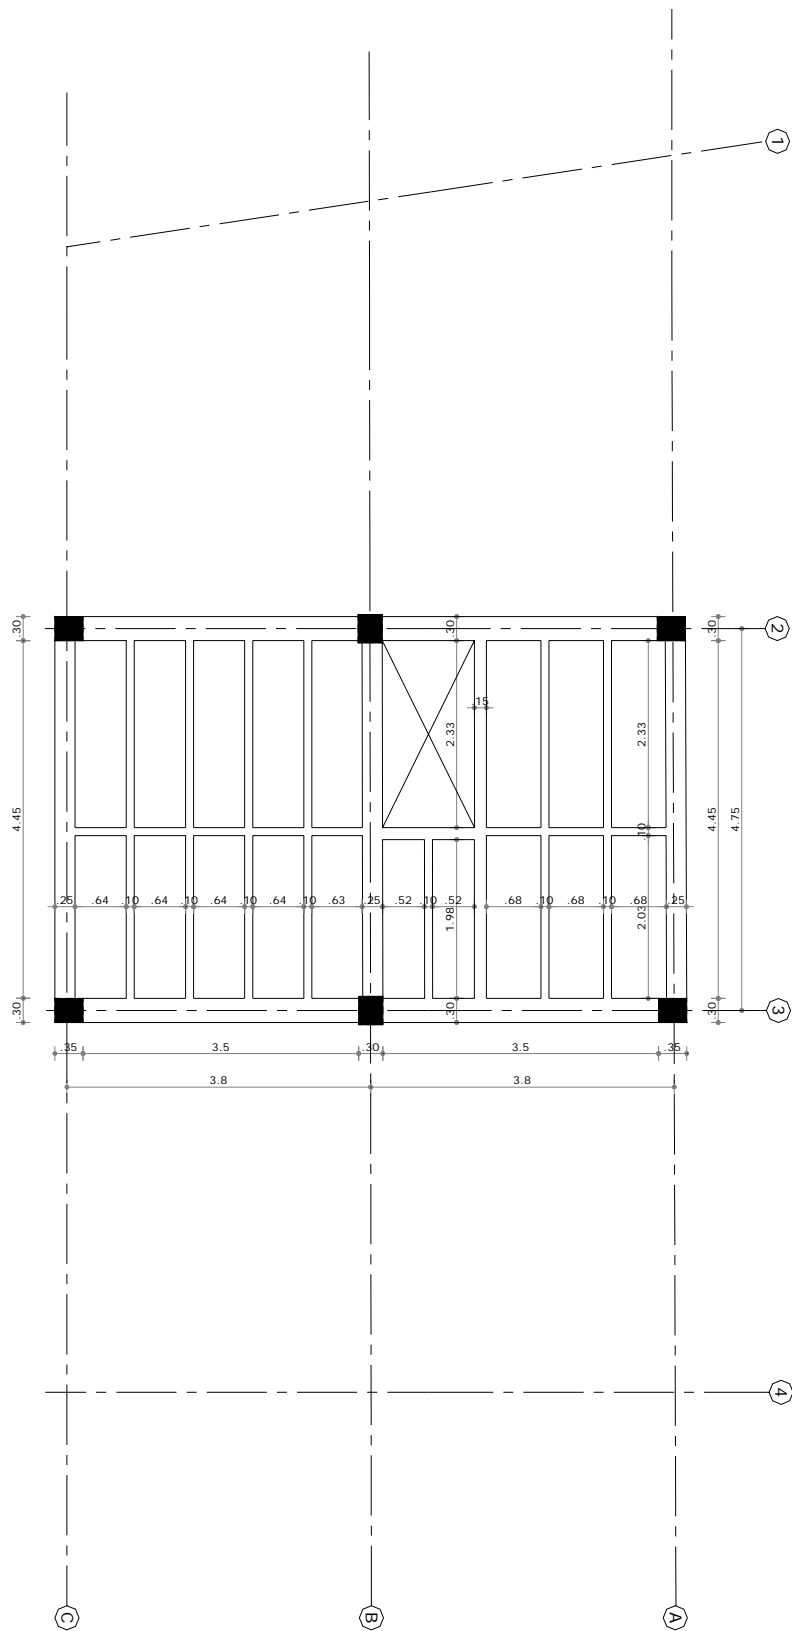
Planta estructural del tercer entrespacio (Attilo) de la edificación tipo.
